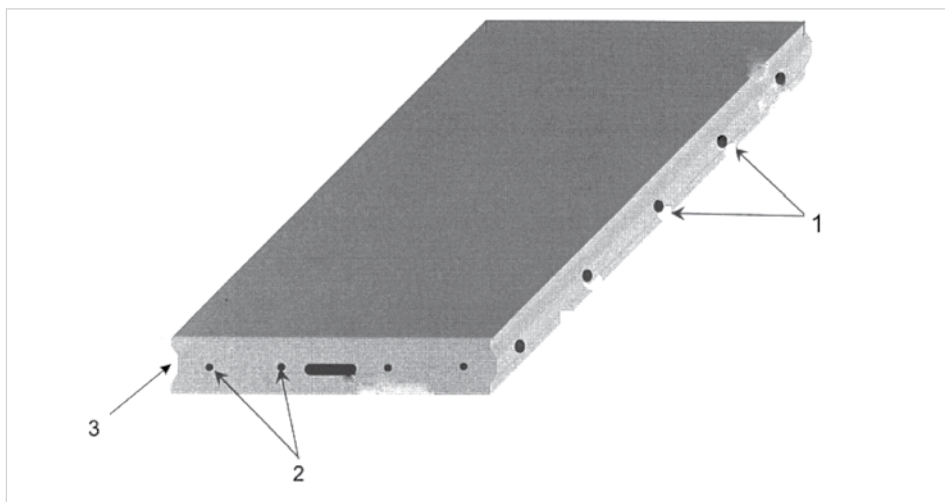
Дорожная плита из преднапряженного бетона для укладки по технологии ИМЭТ-СТРОЙ: 1 – продольные сквозные каналы; 2 – поперечная преднапряженная арматура; 3 – шпунтованные боковые грани (торцы) плит
